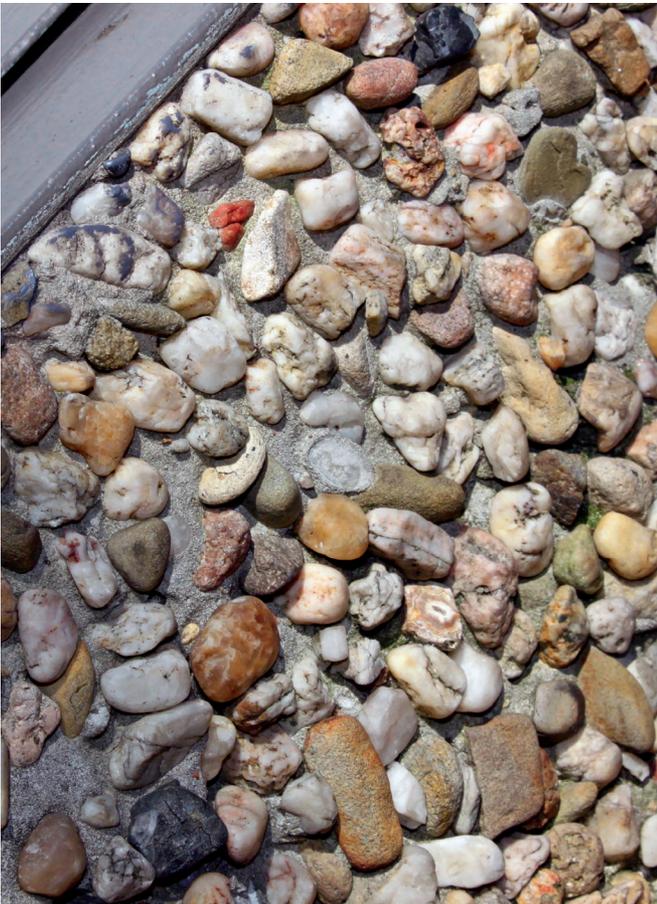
Detailansicht einer Waschbeton-Oberfläche
